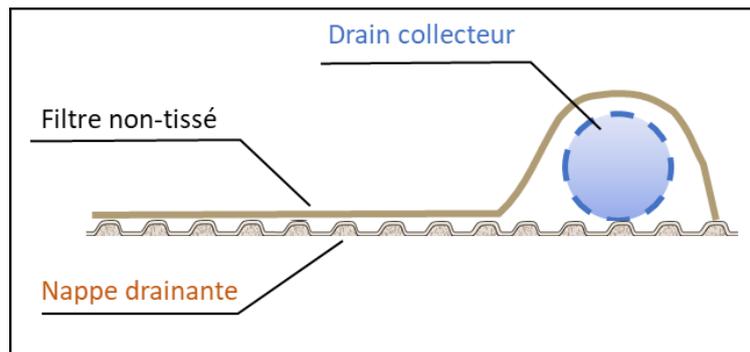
ALVEODRAIN® F - RACCORDEMENT AU DRAIN COLLECTEUR
